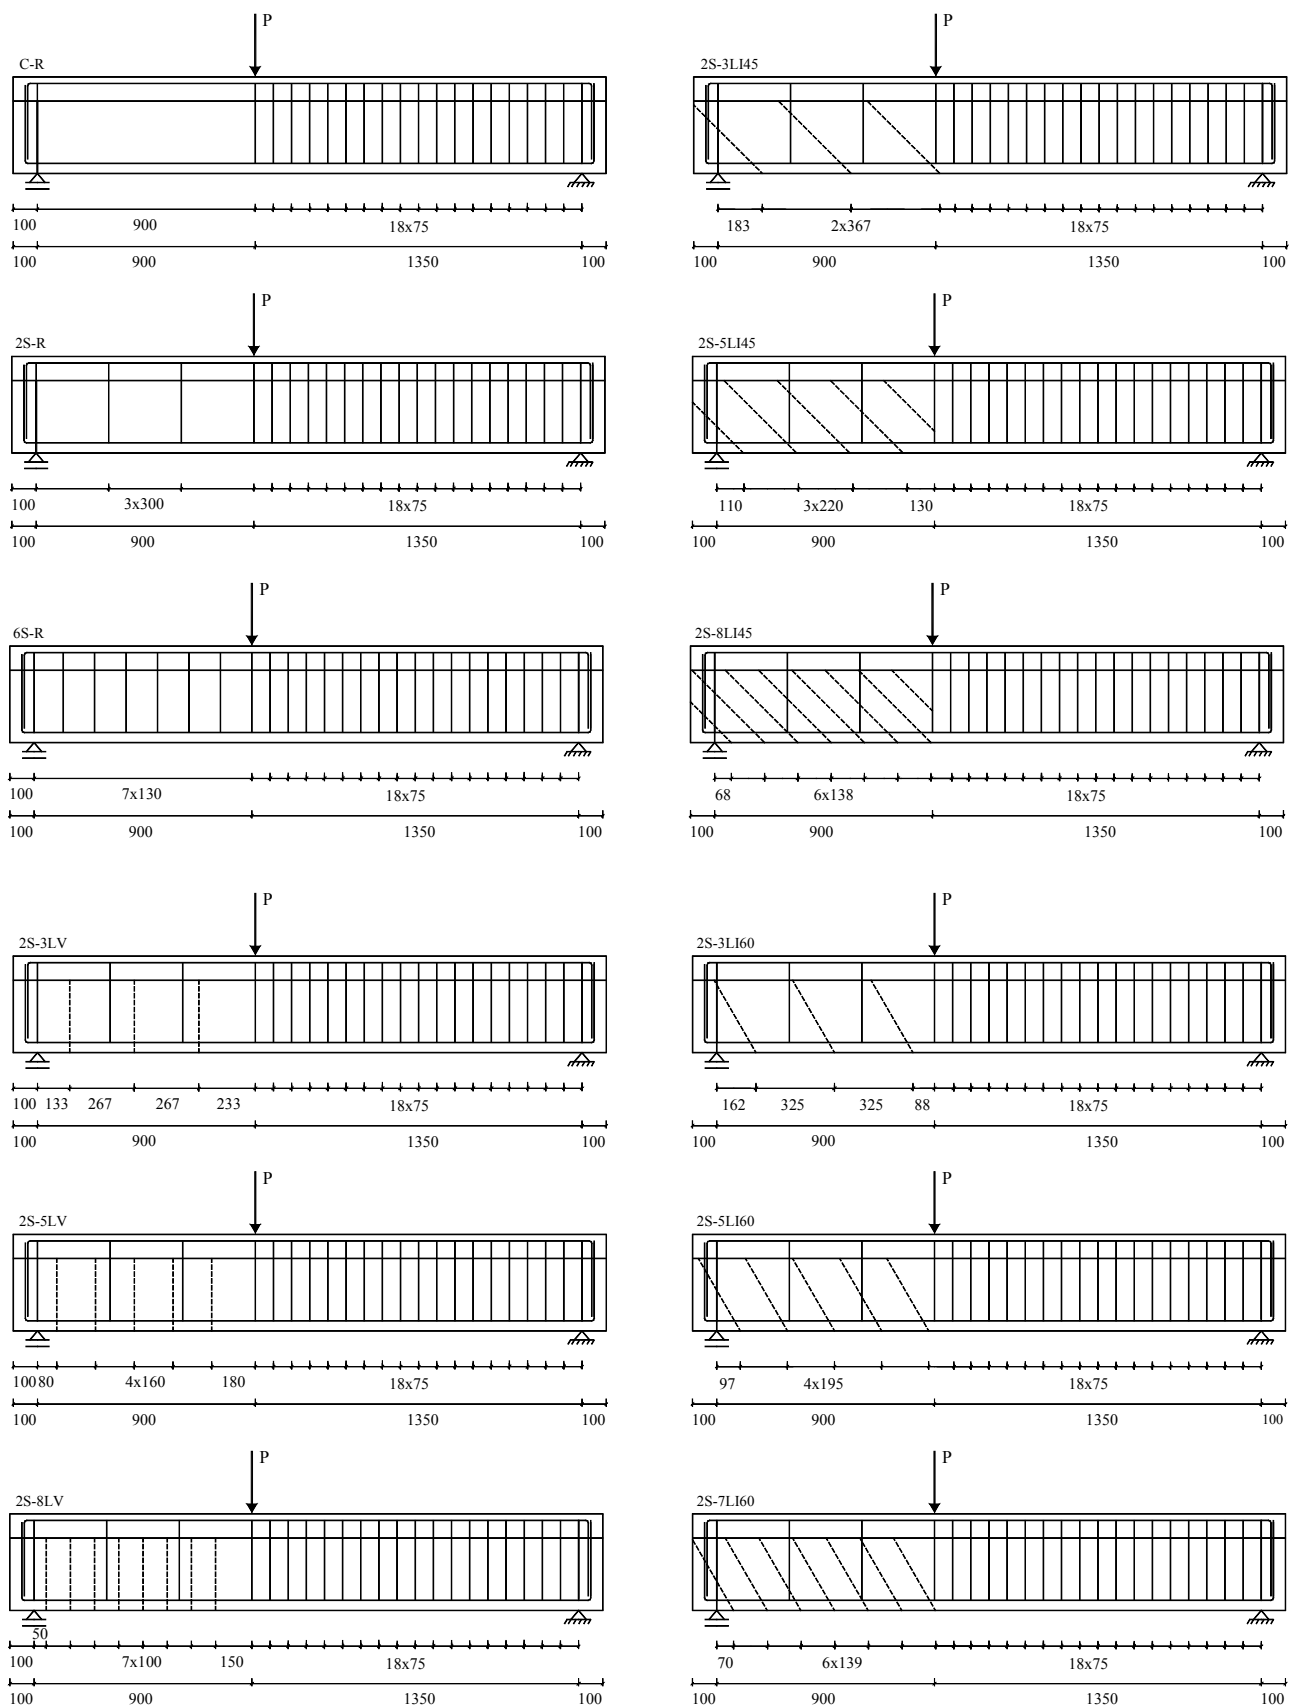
Vigas ensaiadas: localização das armaduras transversais (linha a traço cheio) e dos laminados de CFRP (linha a tracejado) no reforço ao corte
